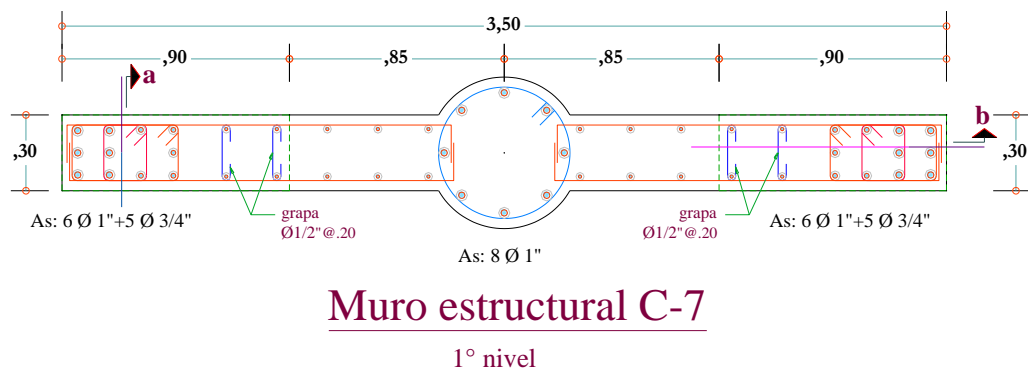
Diseño final de la longitud de confinamiento en muro C-7
